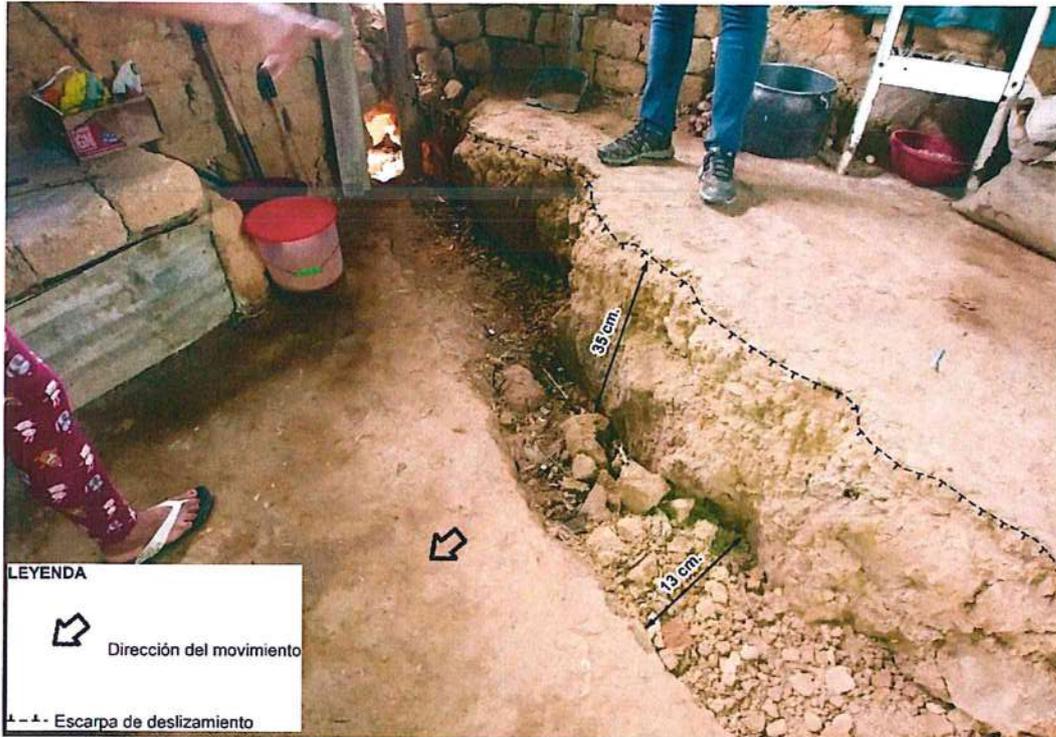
Vista de escarpe de deslizamiento en el interior de una vivienda. La grieta tiene una longitud de 13 cm, aproximadamente.
